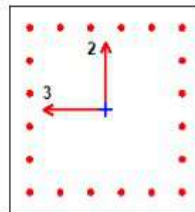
Kebutuhan Tulangan Geser Kolom Lantai Dua
